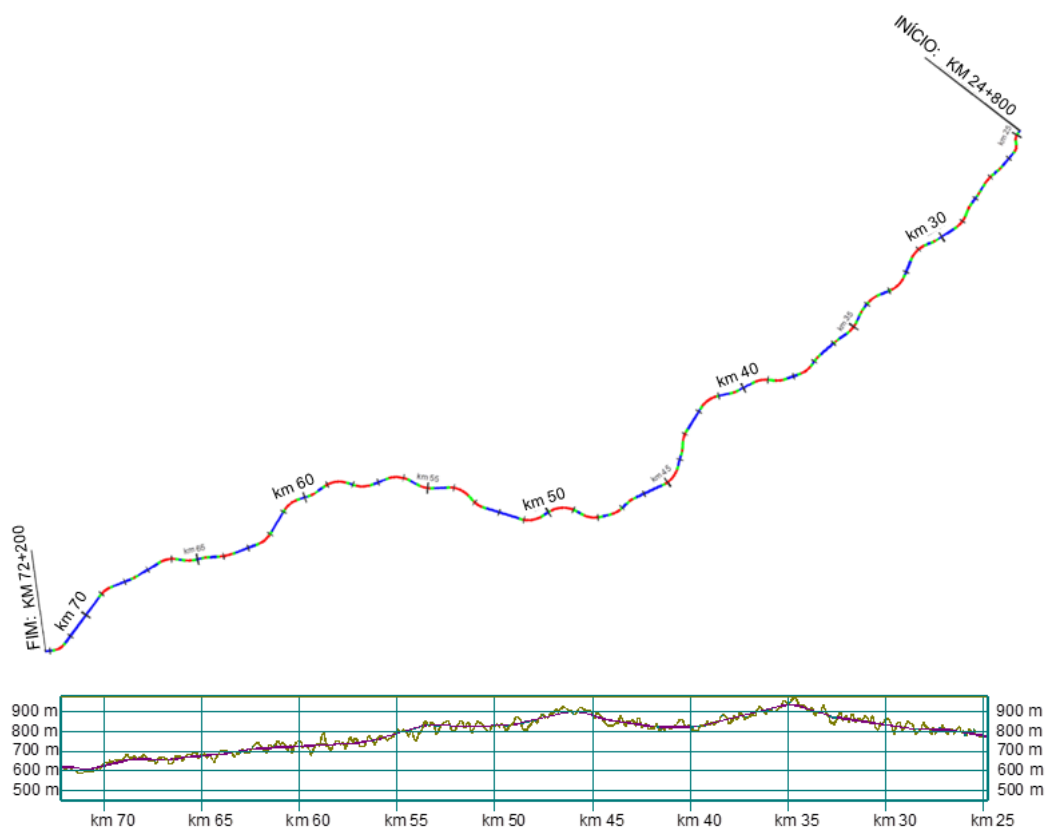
Traçado em planta e perfil do corredor São Paulo - Sorocaba
